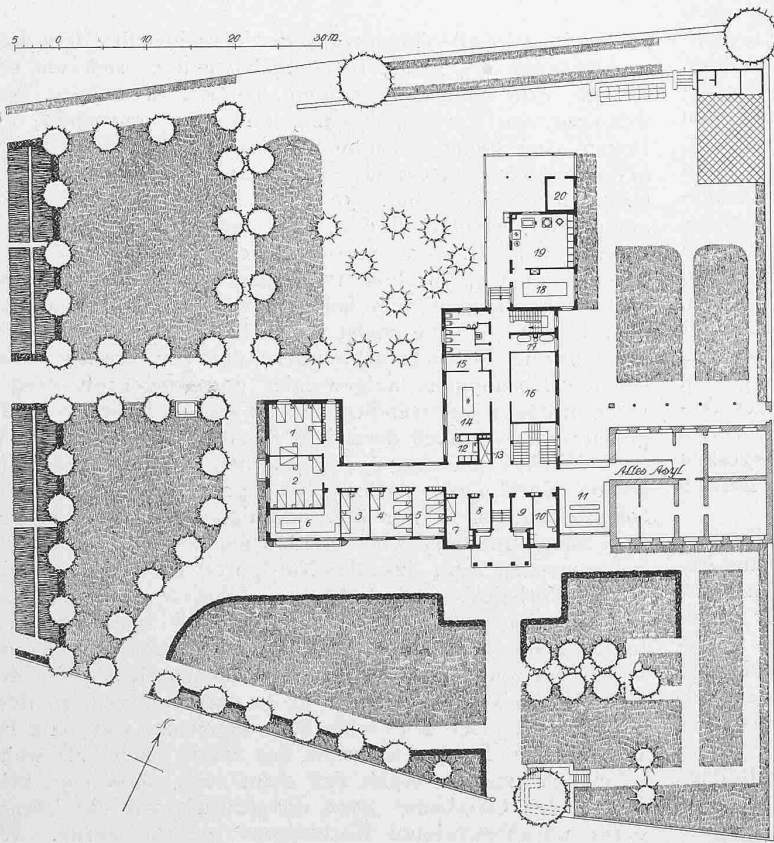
Asyl «Gottesgnad» in Mett bei Biel. — Erdgeschoss mit Lageplan 1 : 800.
